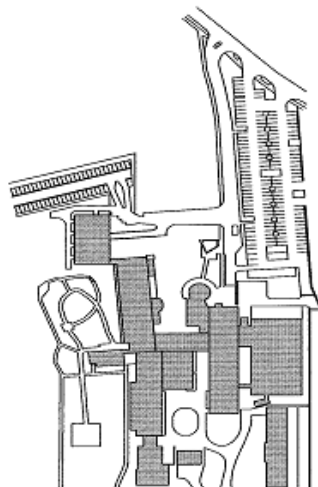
Grundriss Kreisklinik Burghausen
